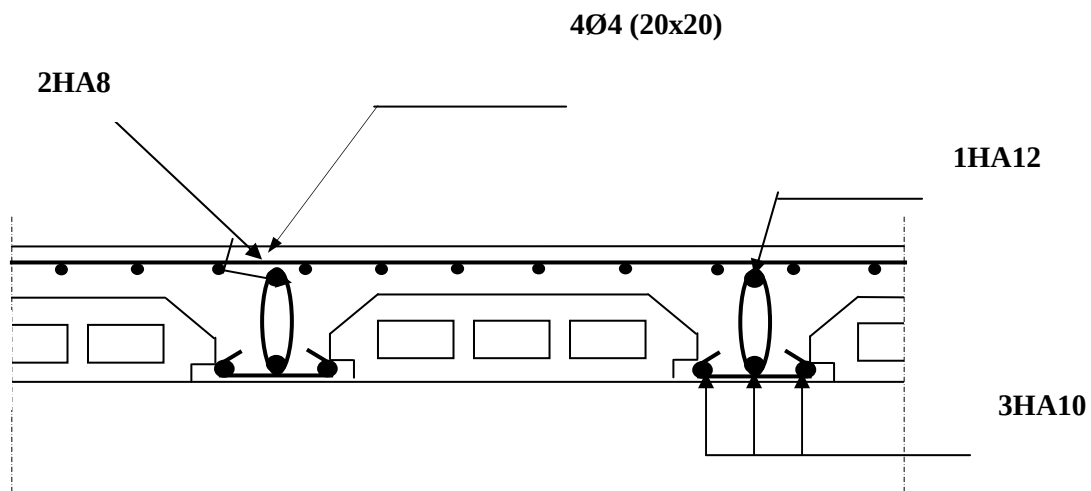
Schéma de ferrailage du plancher d'étage
